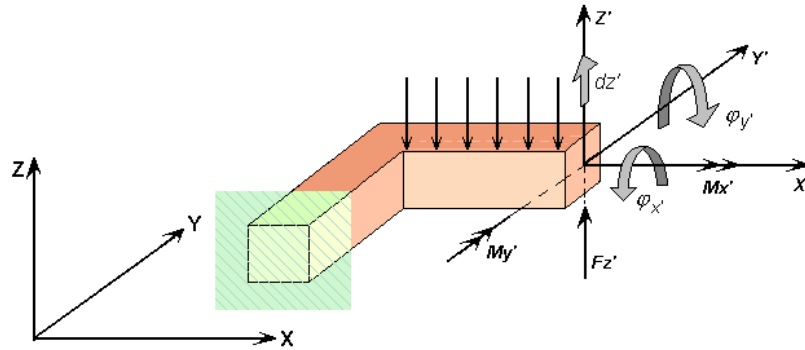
Ejes locales y fuerzas en los mismos en un elemento de retícula plana.
